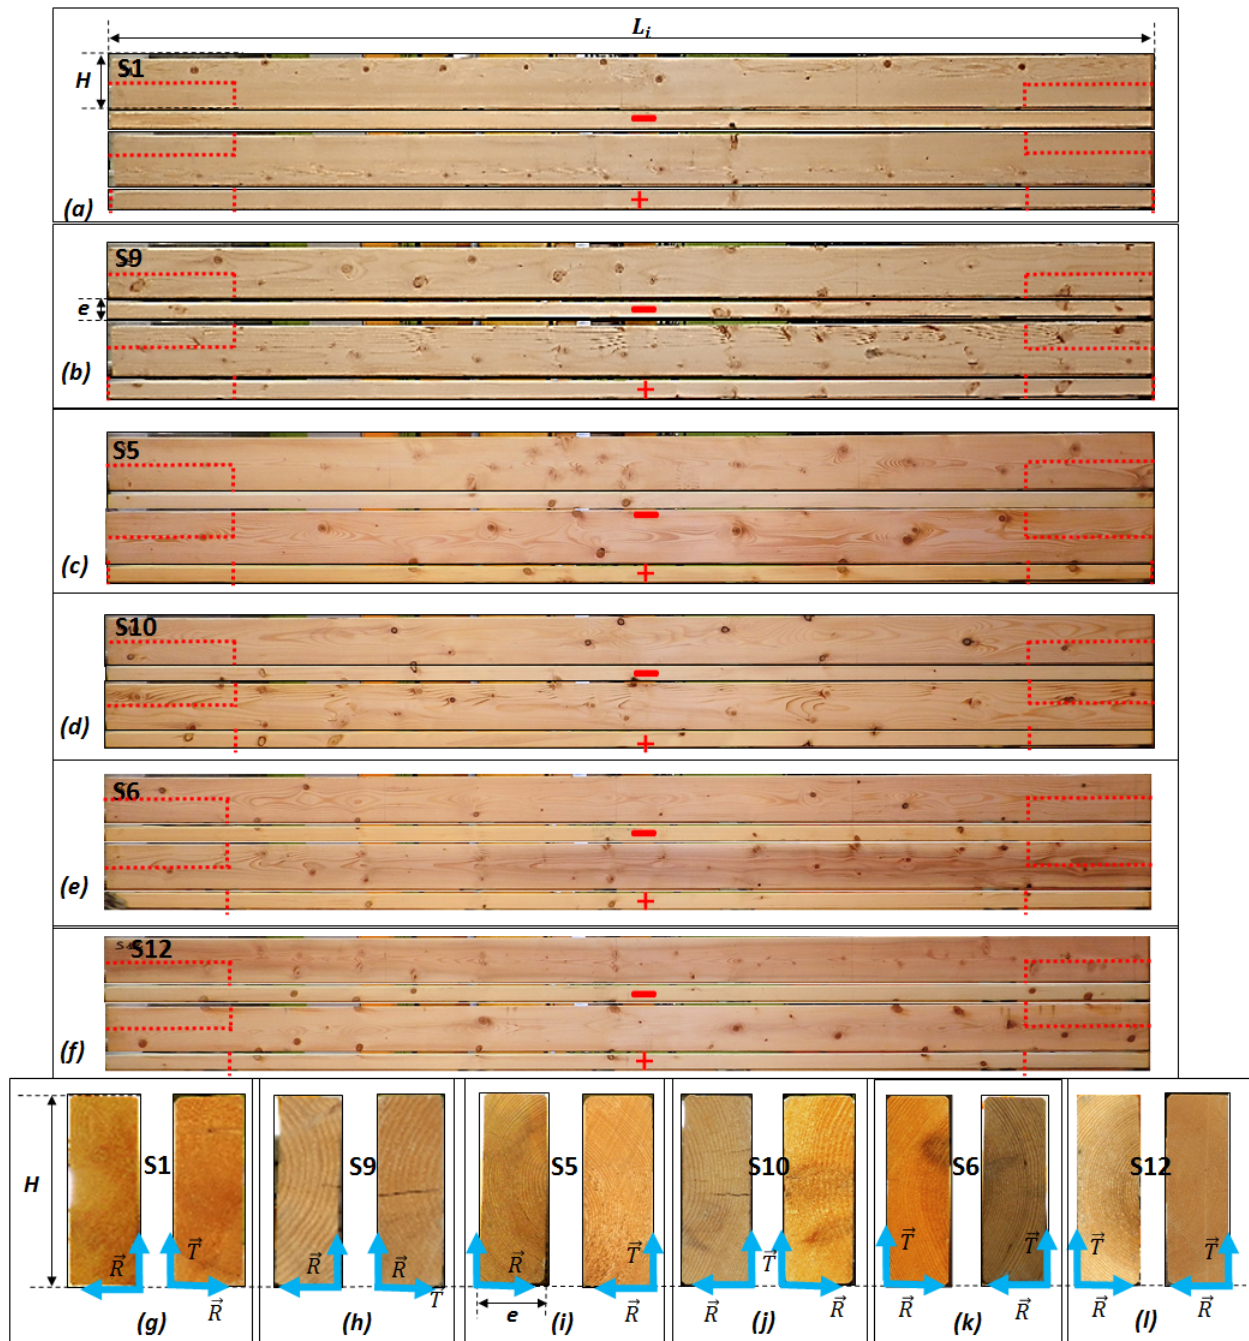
Surfaces externes des poutres de Sapin (S) utilisées : (a,g) poutre S1 ; (b,h) poutre S9 ; (c,i) poutre S5 ; (d,j) poutre S10 ; (e,k) poutre S6 ; (f,l) poutre S12. Sur les faces latérales des poutres, (-) indique la face chargée en compression, (+) la face chargée en traction. Les traits pointillés en rouge indiquent les parties qui seront retirées pour l’obtention des poutres entaillées. Sur les images inférieures des sections transversales, les directions radiales ( $\vec{R}$ ) et tangentielles ( $\vec{T}$ ) sont approximativement indiquées.
